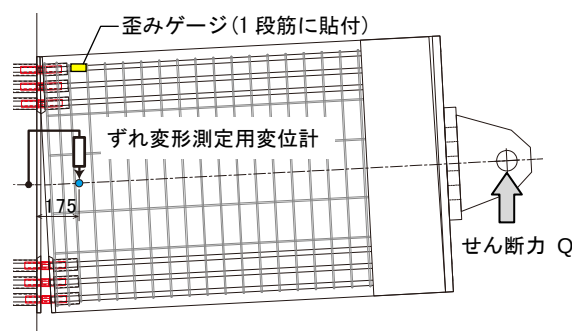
歪みゲージ貼付位置およびずれ変形測定位置
